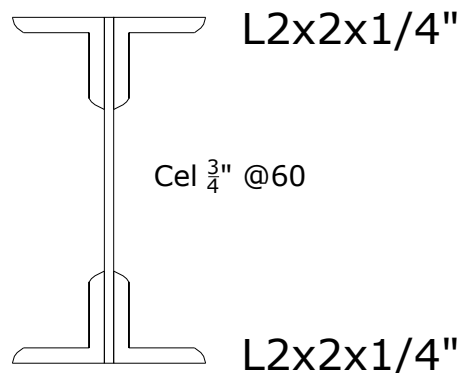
Diseño de viga primaria estructura de techo ASD (propuesta como viga macomber)
